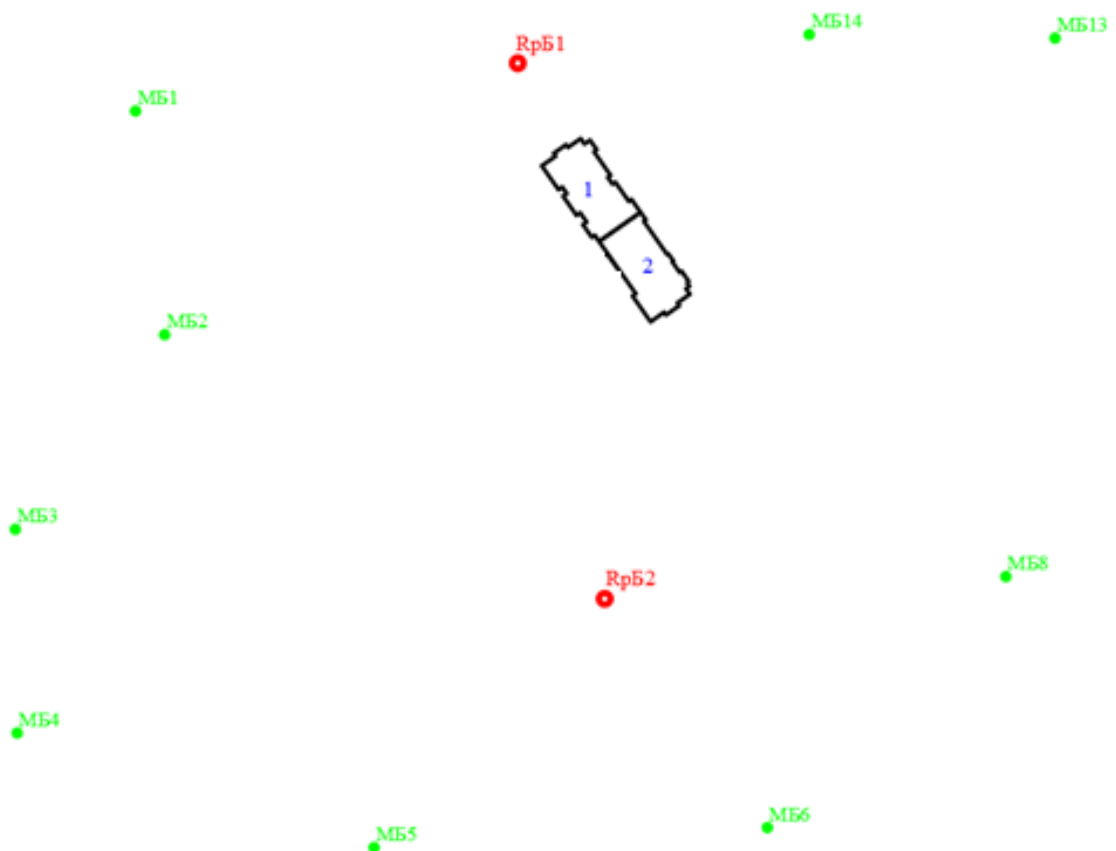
Схема расположения опорных реперов и марок на площадке Б
